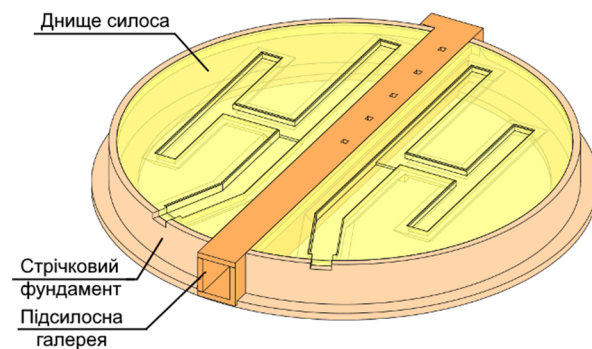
Модель фундаменту (окрема фундаментна стрічка під стінками силосу, підземна галерея та днище) силосу
